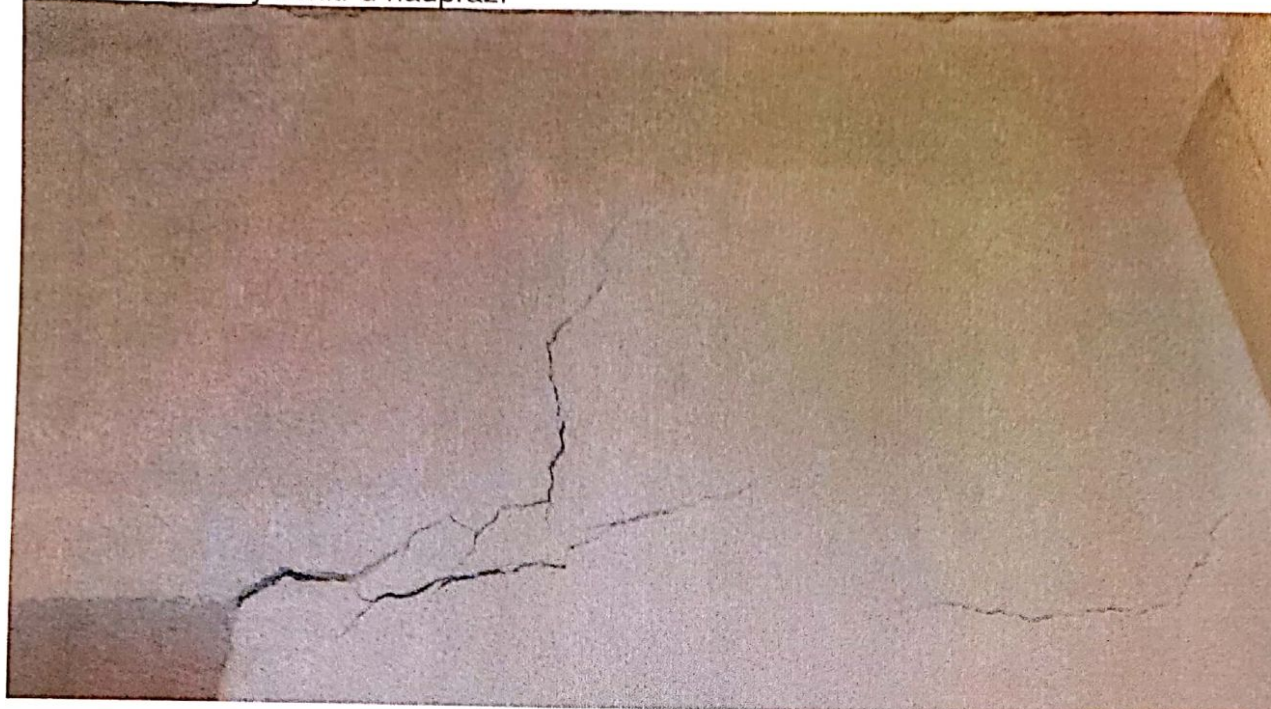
Svislá trhlina podél styku částí objektu, narušená konstrukce stropu
